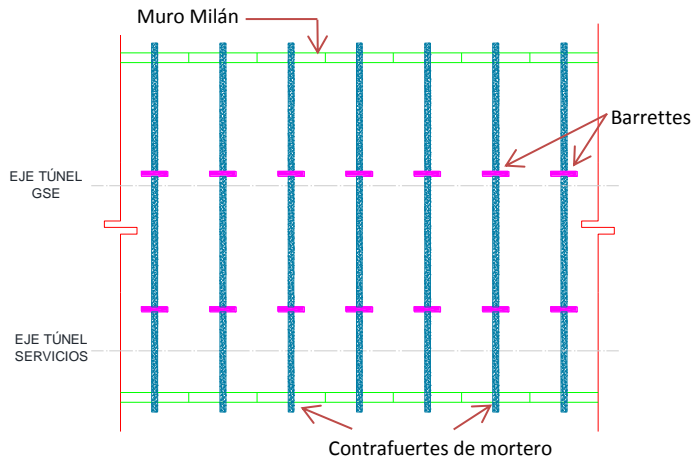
Planta de arreglo de Muro Milán, Contrafuertes y Barretes.
